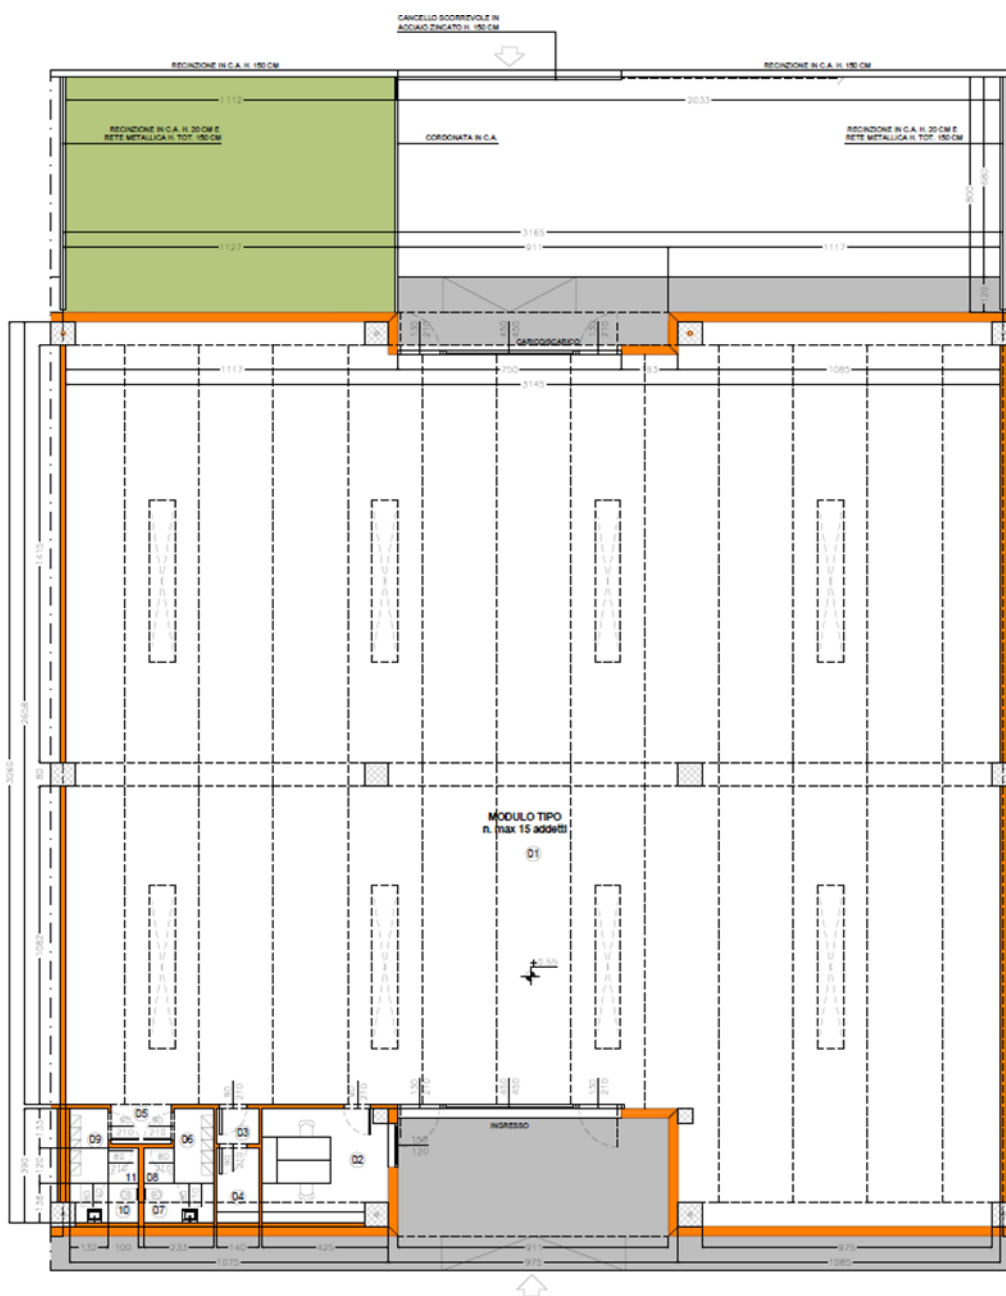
Estratto – progetto pianta modulo tipo attività produttive
